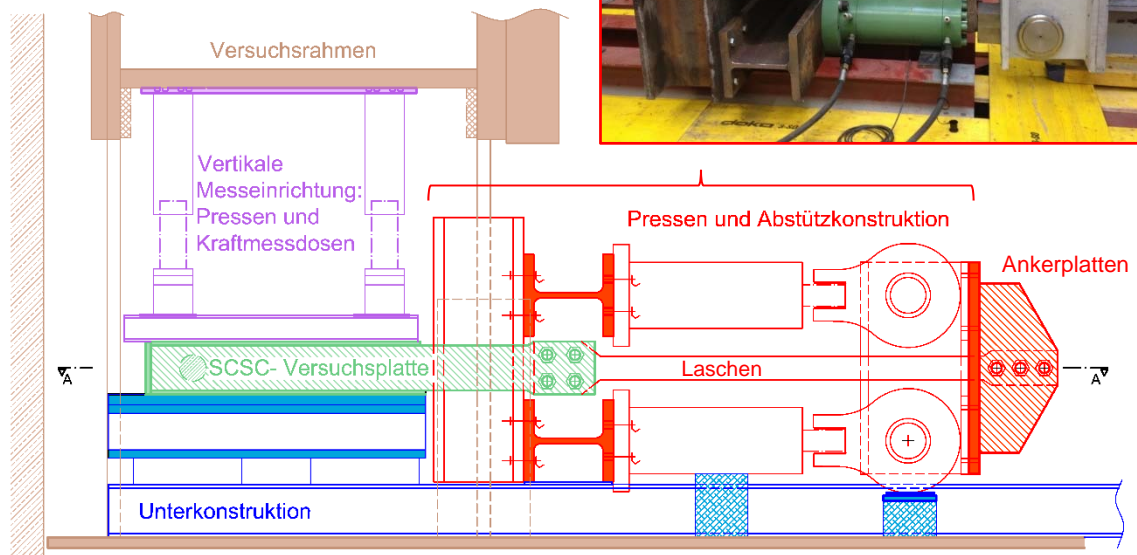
Grundriss und Schnitt der Versuchsanlage der Vorversuche samt eingebauten Probekörper des Querschnitts-Typs 1
